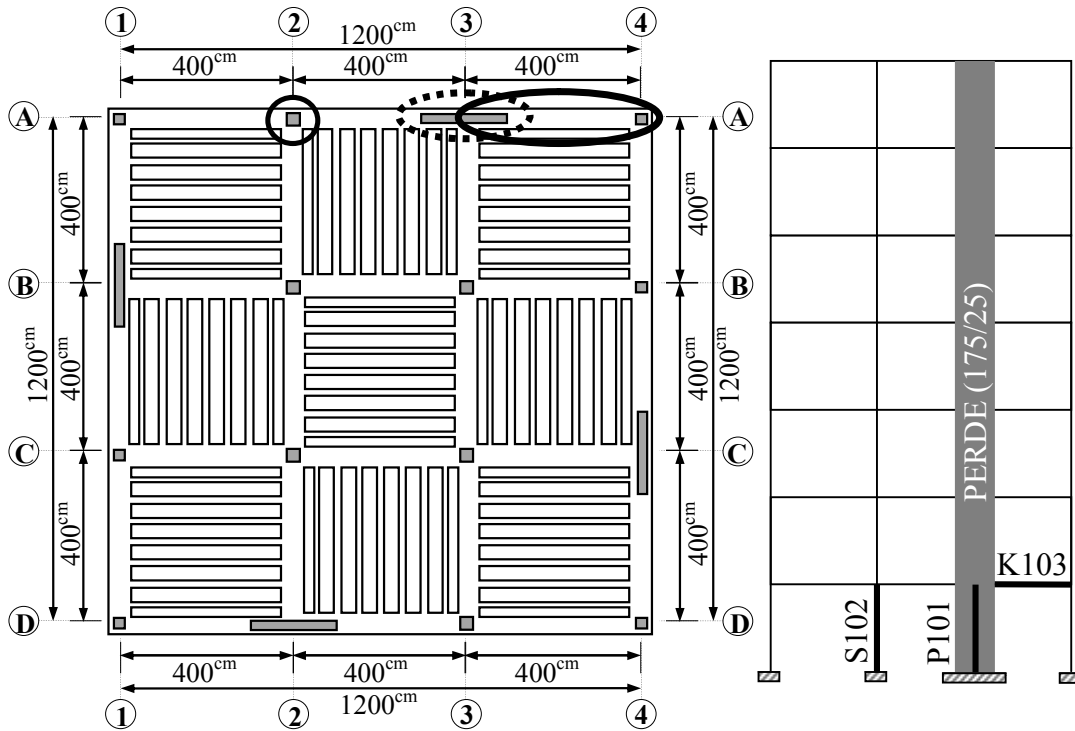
7KPÇB-1'de Tipik Kiriş Detayı
